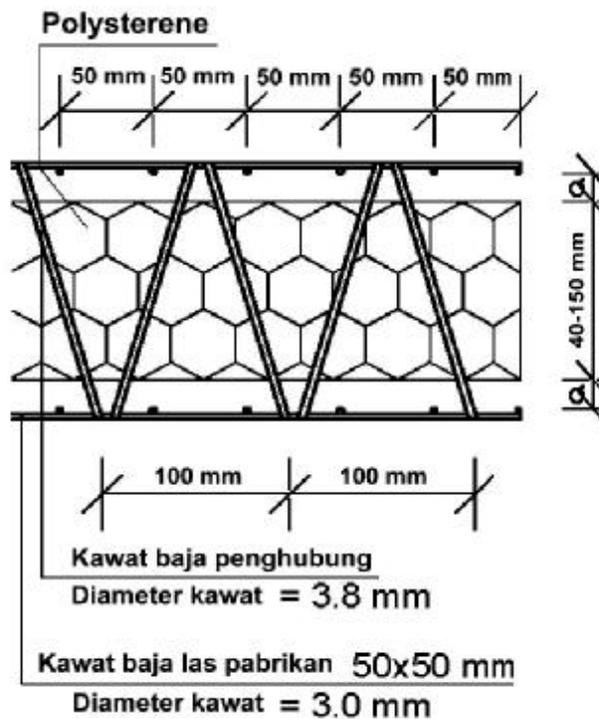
Detail struktur panel jaring kawat baja tiga dimensi
